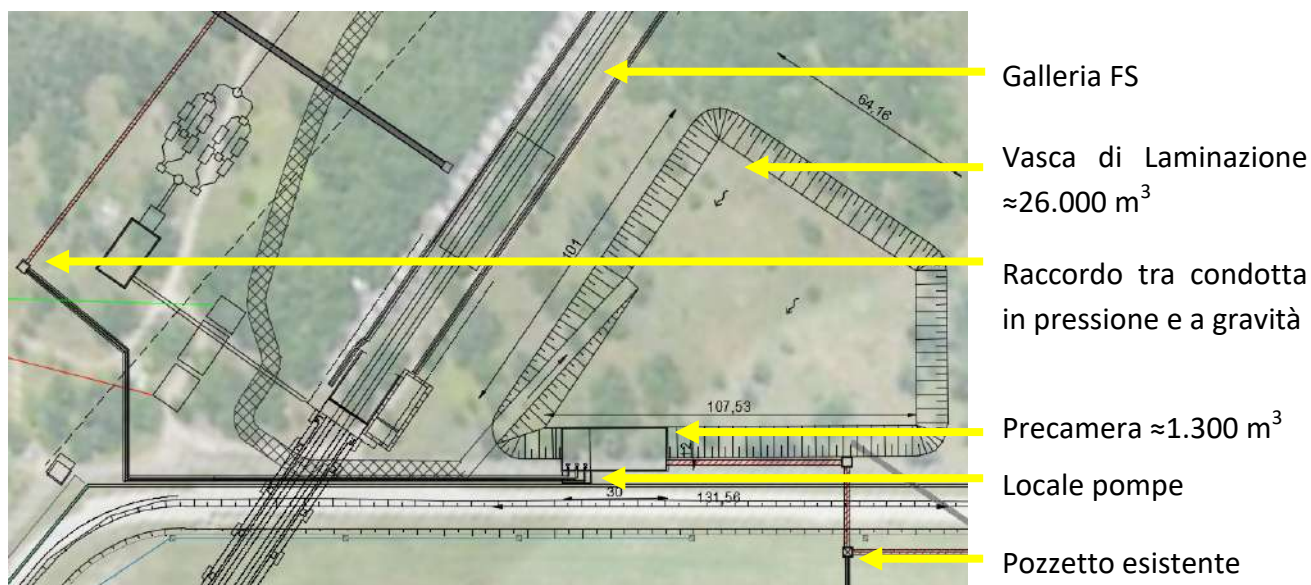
planimetria di progetto nell'ipotesi di passare sopra alla ferrovia (versione 2)
